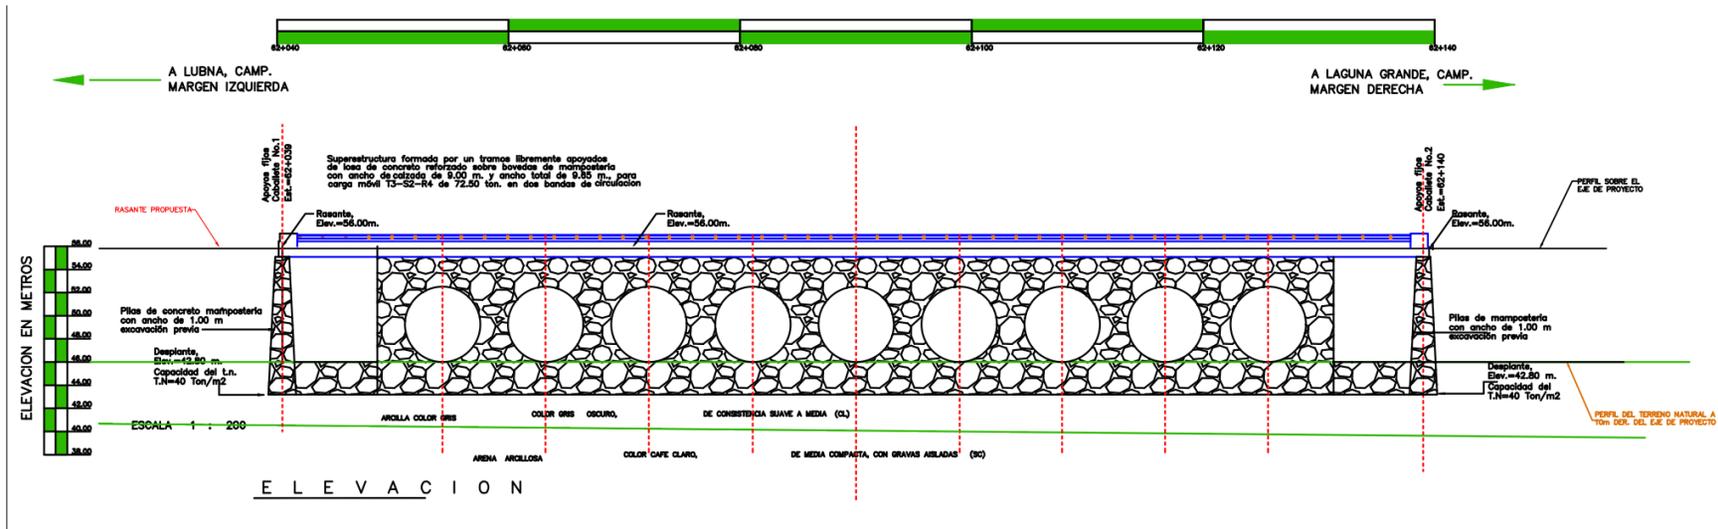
Sección estructural en elevación Puente Chilam-Balam, Km 62+085.30
